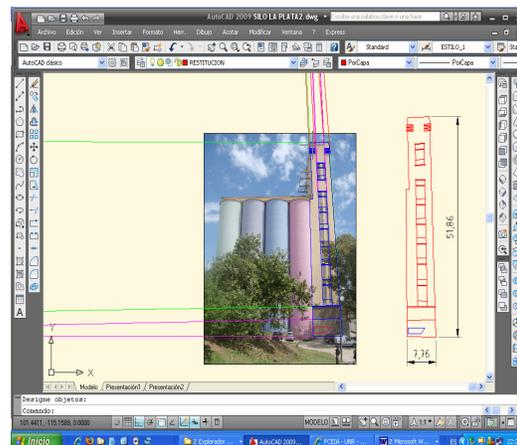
Dibujo sobre foto y fachada restituida (Experiencia 1)
